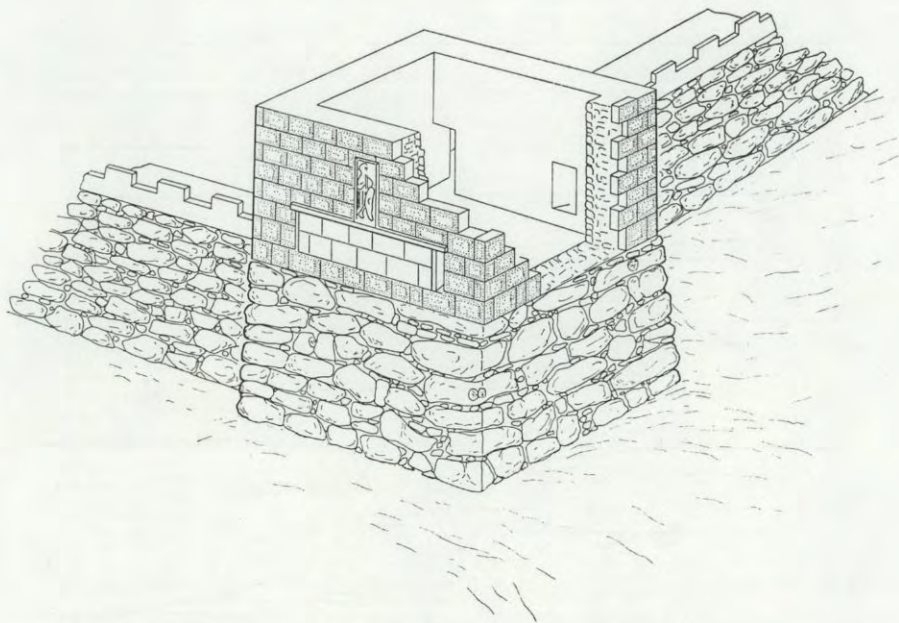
Tarragona, Torre de Minerva. Vista de la torre hipotéticamente reconstruida con el tramo Sur. Cámara de la torre con las saeteras.
